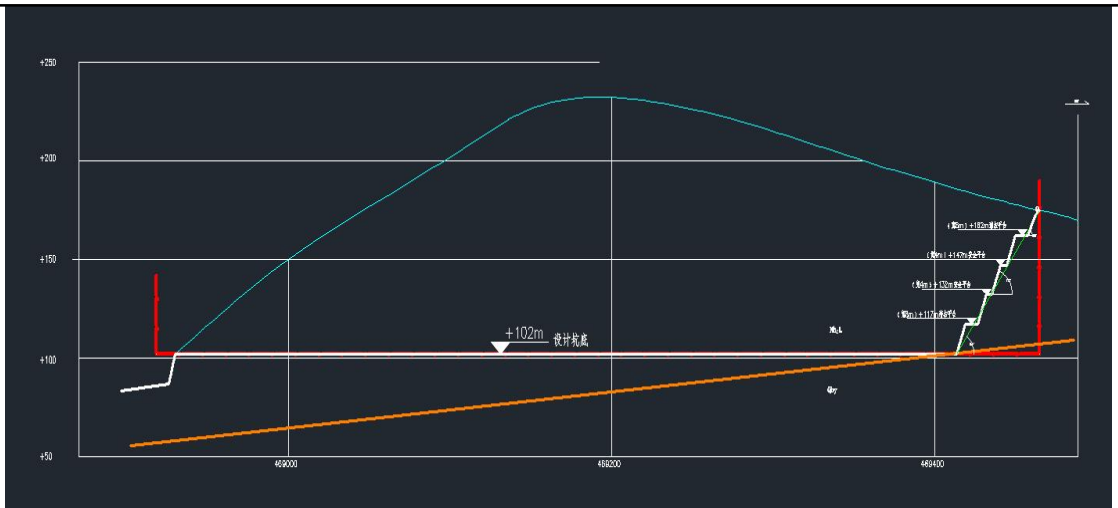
露天采场终了境界 B 线设计剖面图（比例尺 1:1000）
